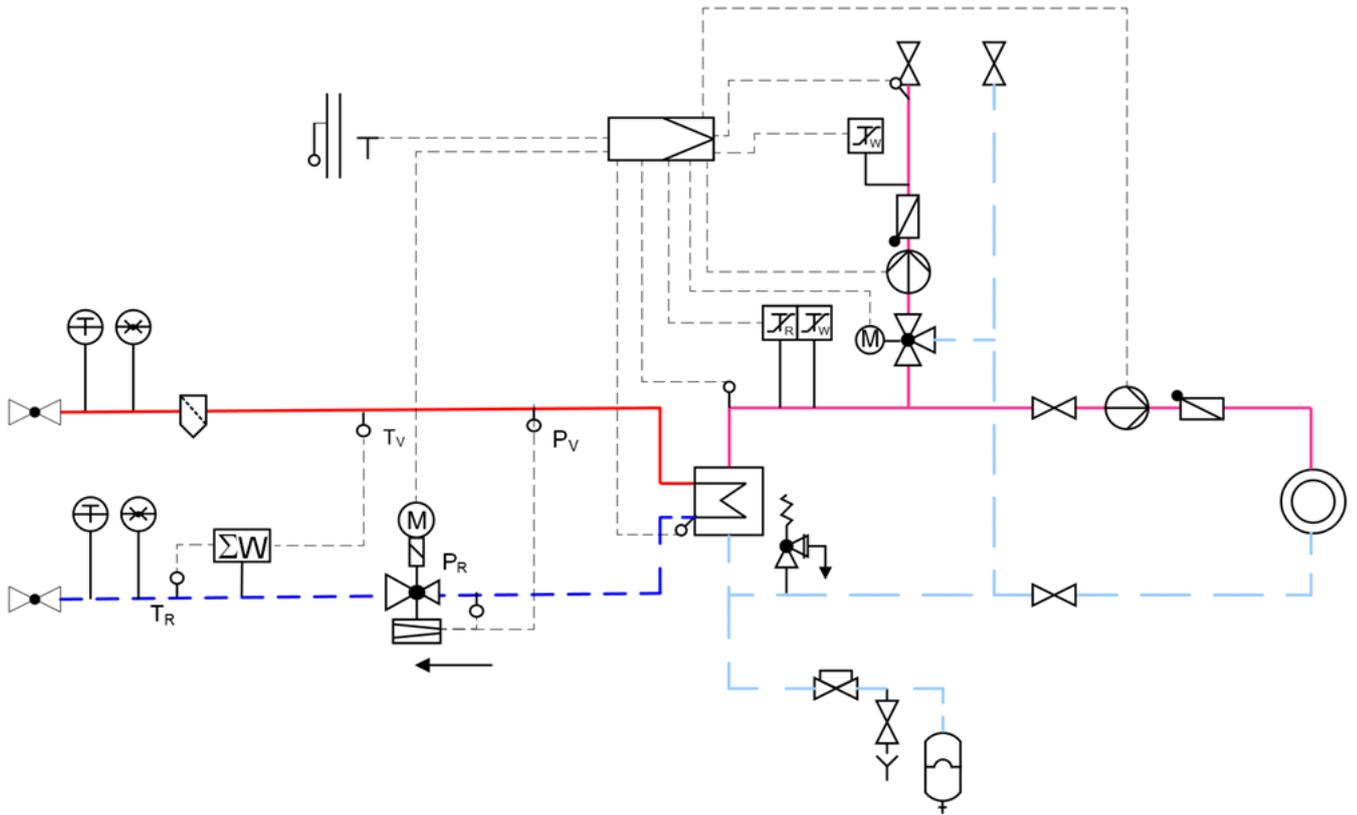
Prinzipielle Anordnung einer Hausstation in der Übergabestation
